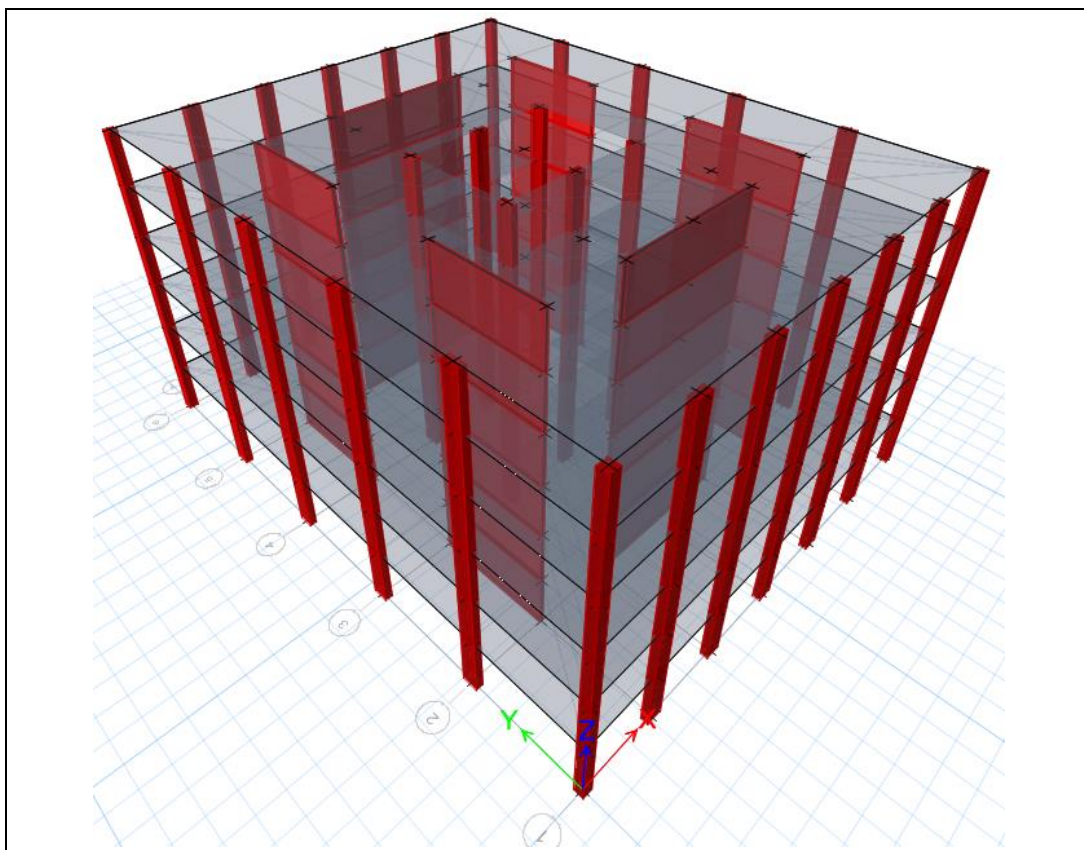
Vista en 3D del Sistema estructural convencional. Fuente: Propia
